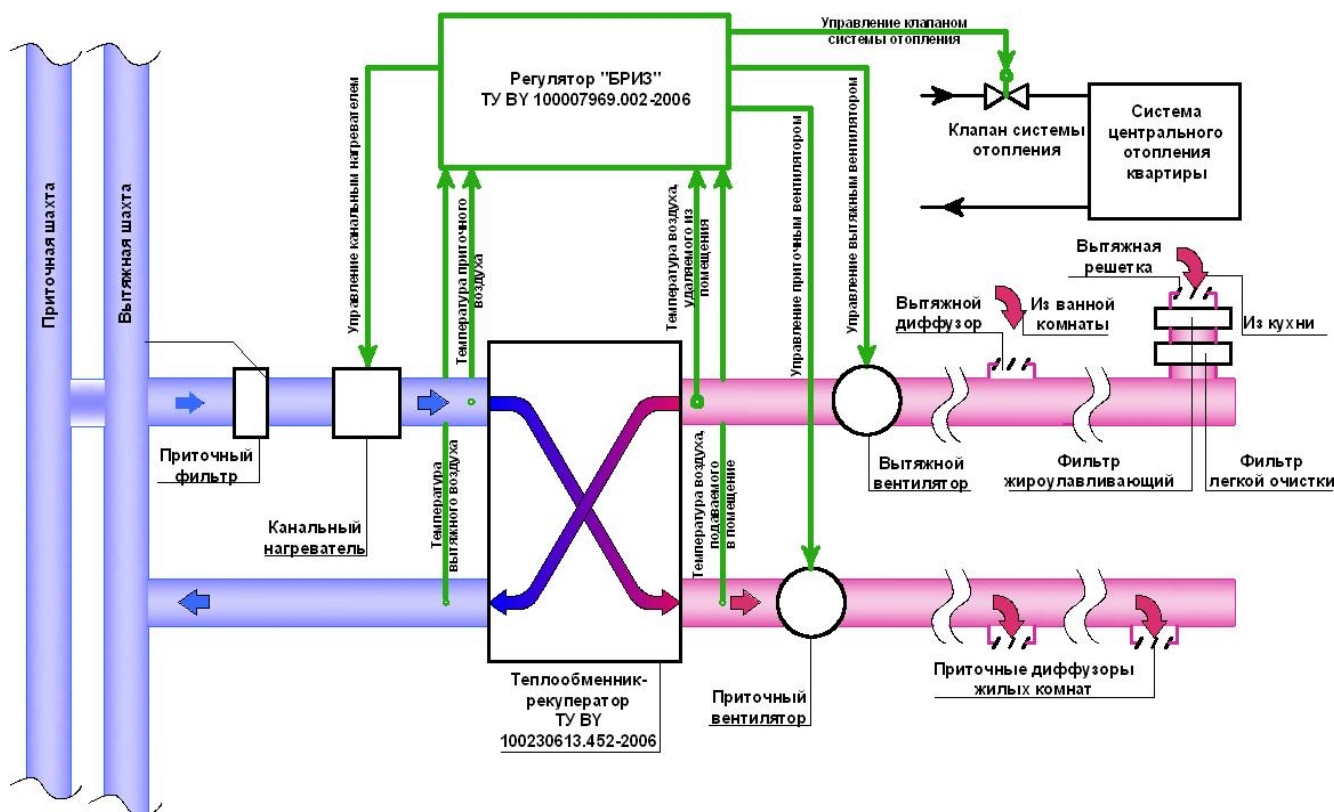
Принципиальная схема системы вентиляции в квартире
